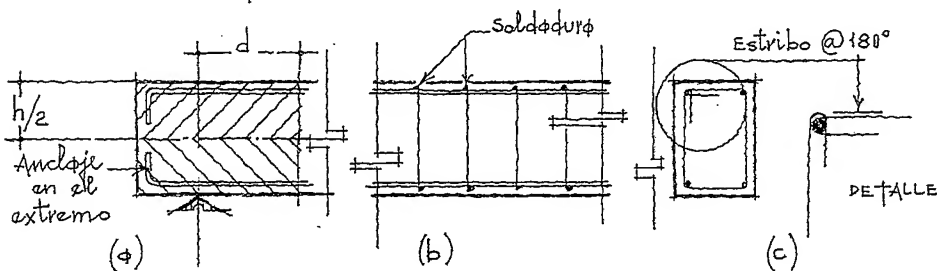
Soldadura para unir ambos elementos, (b)
